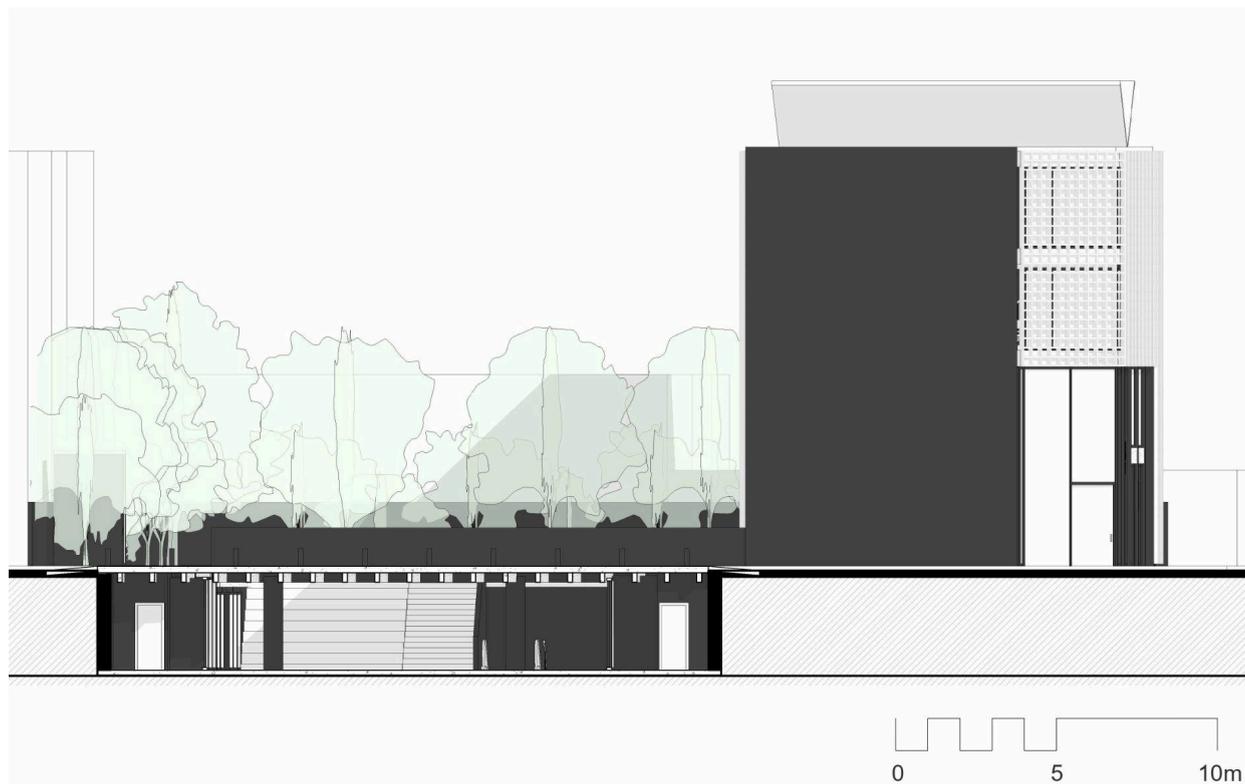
Elevación fachada norte terreno (1) calle Catedral. Fuente: Elaboración propia.
